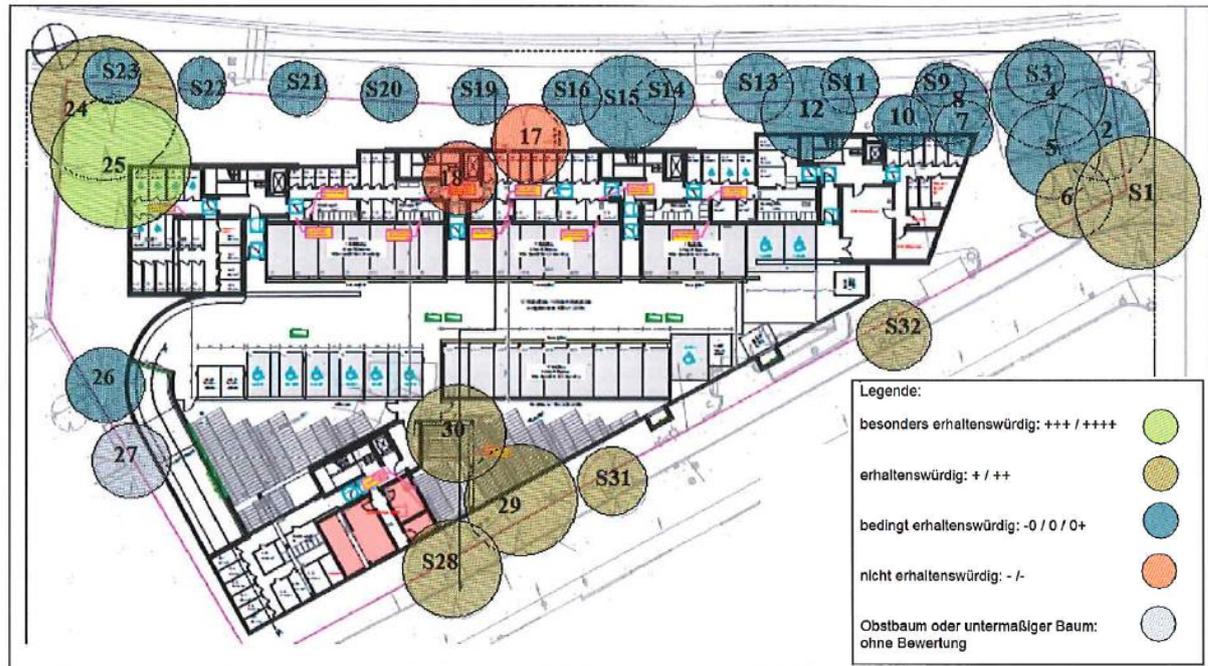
vorhandene Baumstandorte und Bewertung (U. Thomsen, 19.03.2019)
